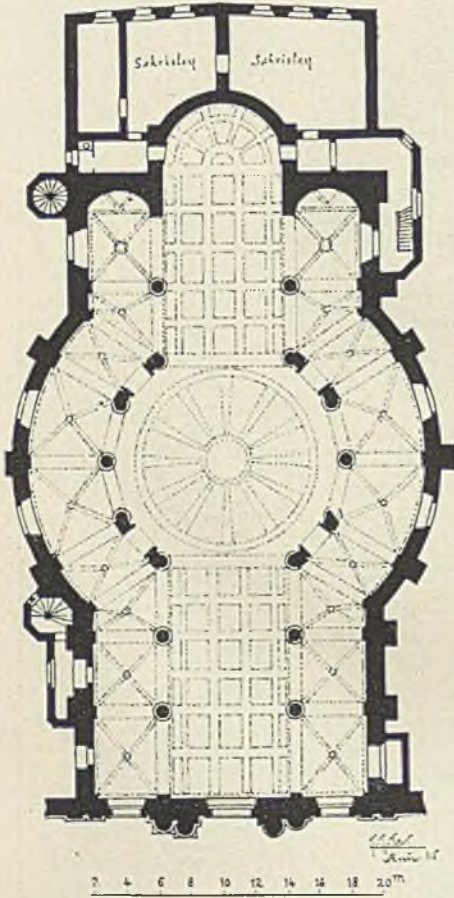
Grundriß von Notre Dame d'Hanswyk zu Mècheln
